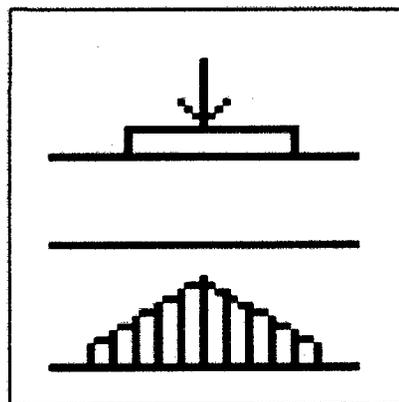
Distribución de esfuerzos de un pavimento flexible.
